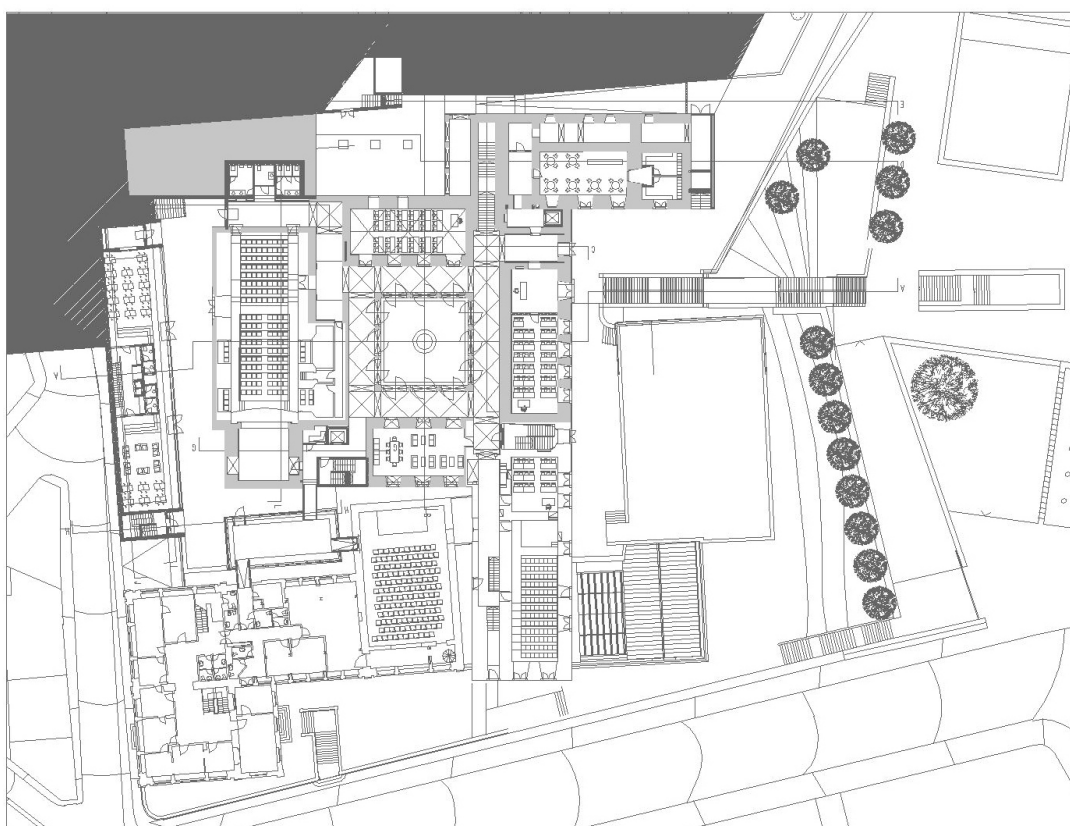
Planta del proyecto para la intervención del núcleo de las Inglesinhas. Primer nivel del claustro. Ver planos en anexo para mayor detalle.
